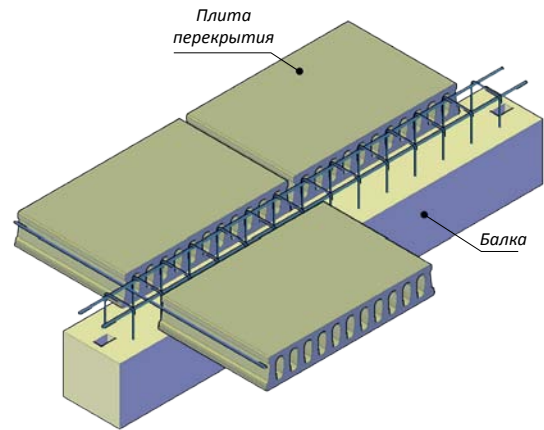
Соединения R-балки дополнительными стержнями с колонной и многопустотными плитами перекрытия.
